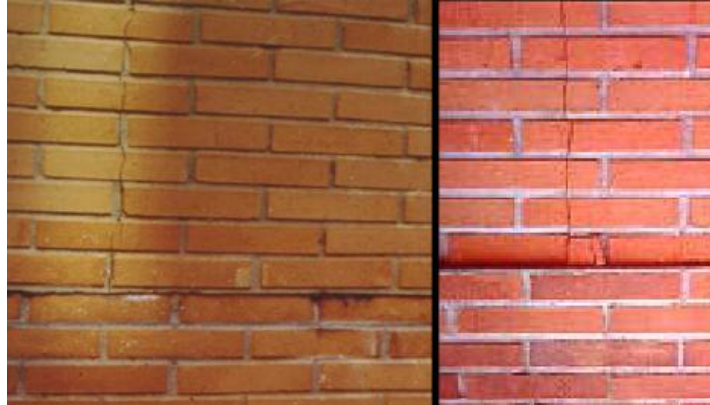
Fisuras verticales en fachadas de ladrillo
